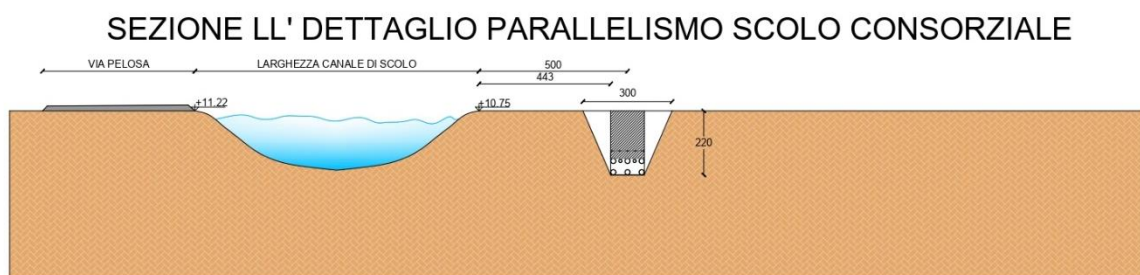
Sezione L-L' – Parallelismo canale di scolo e cavidotto
